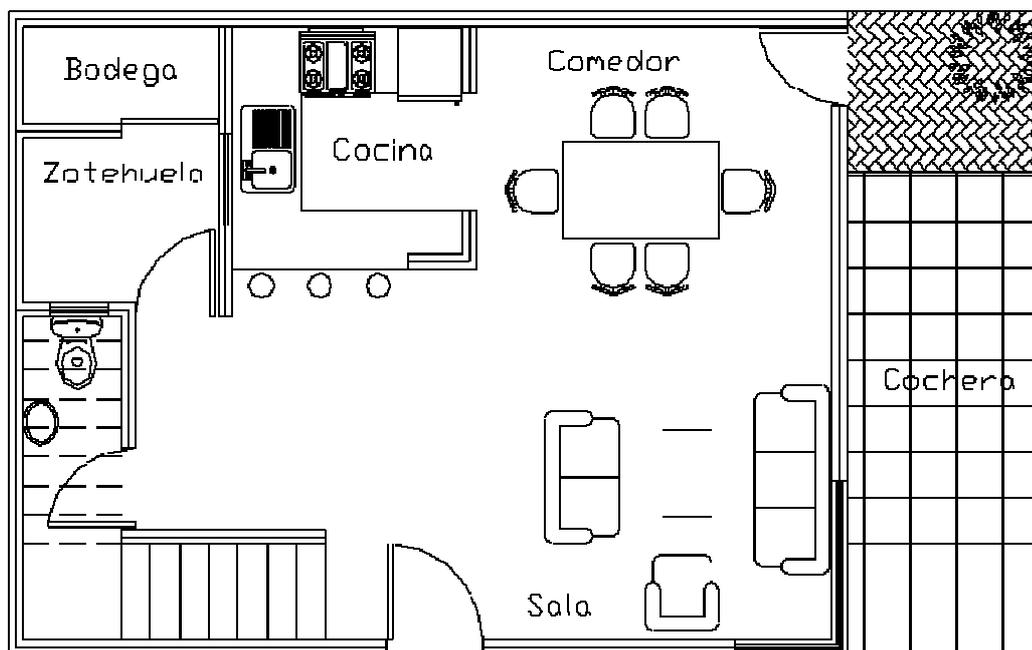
Plano arquitectónico de la planta baja de la casa habitación.
